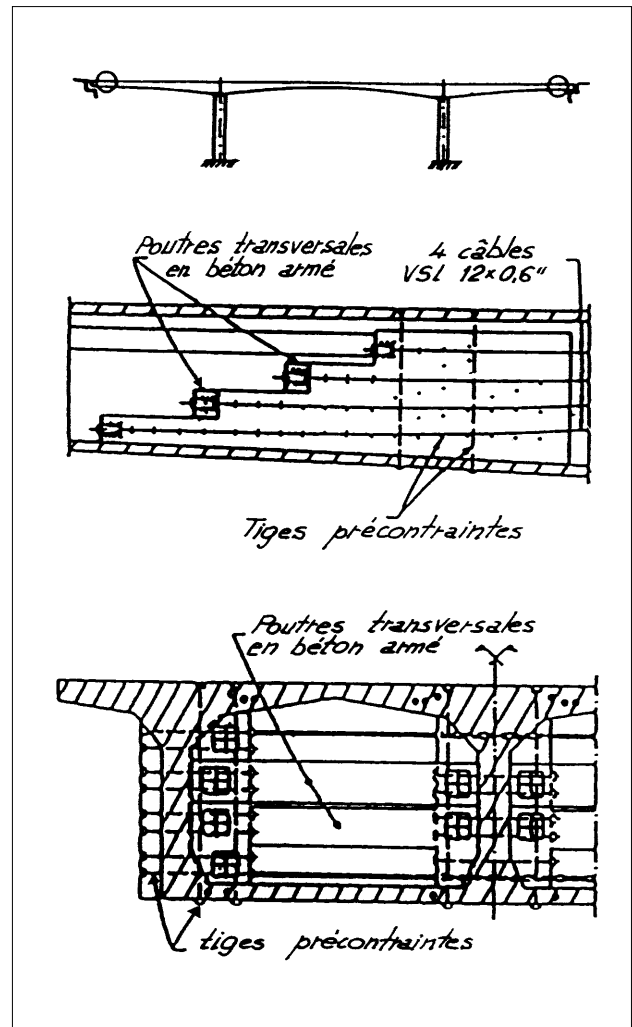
Forme de la zone d'ancrage à l'exemple du viaduc los Chorros (Zahn/Voumard, 1992).
